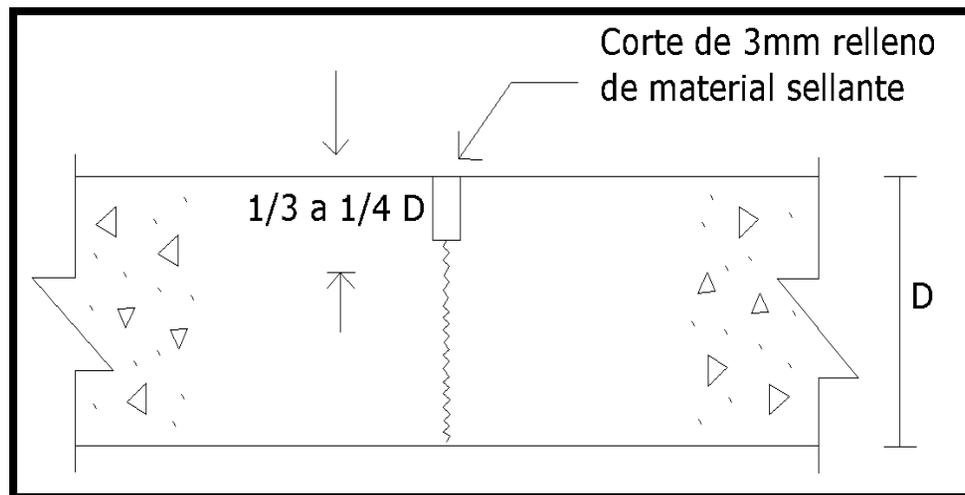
Juntas de contracción para pavimentos rígidos.
